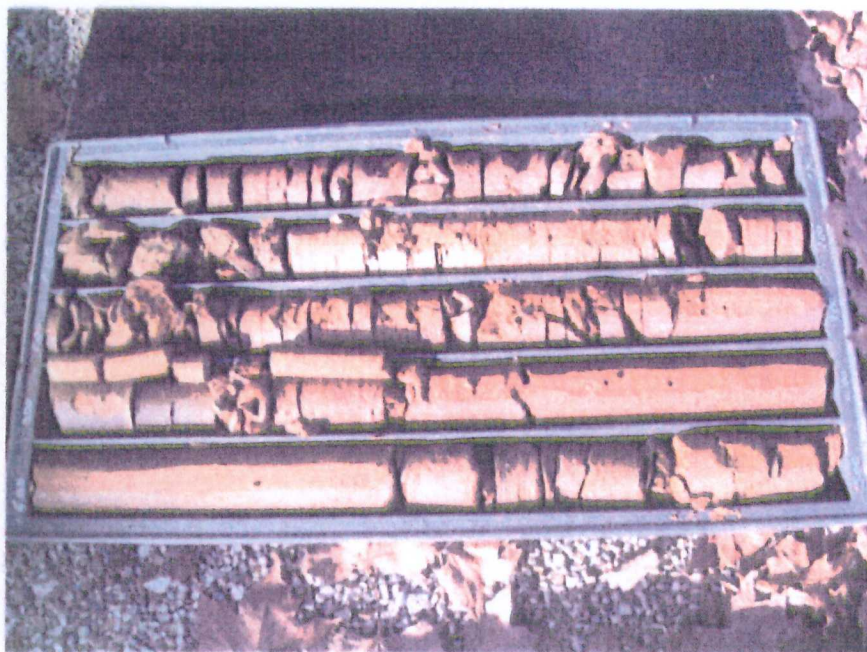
sondaggio S2 cassa 1 da m. 0.00 a m. 5.00
